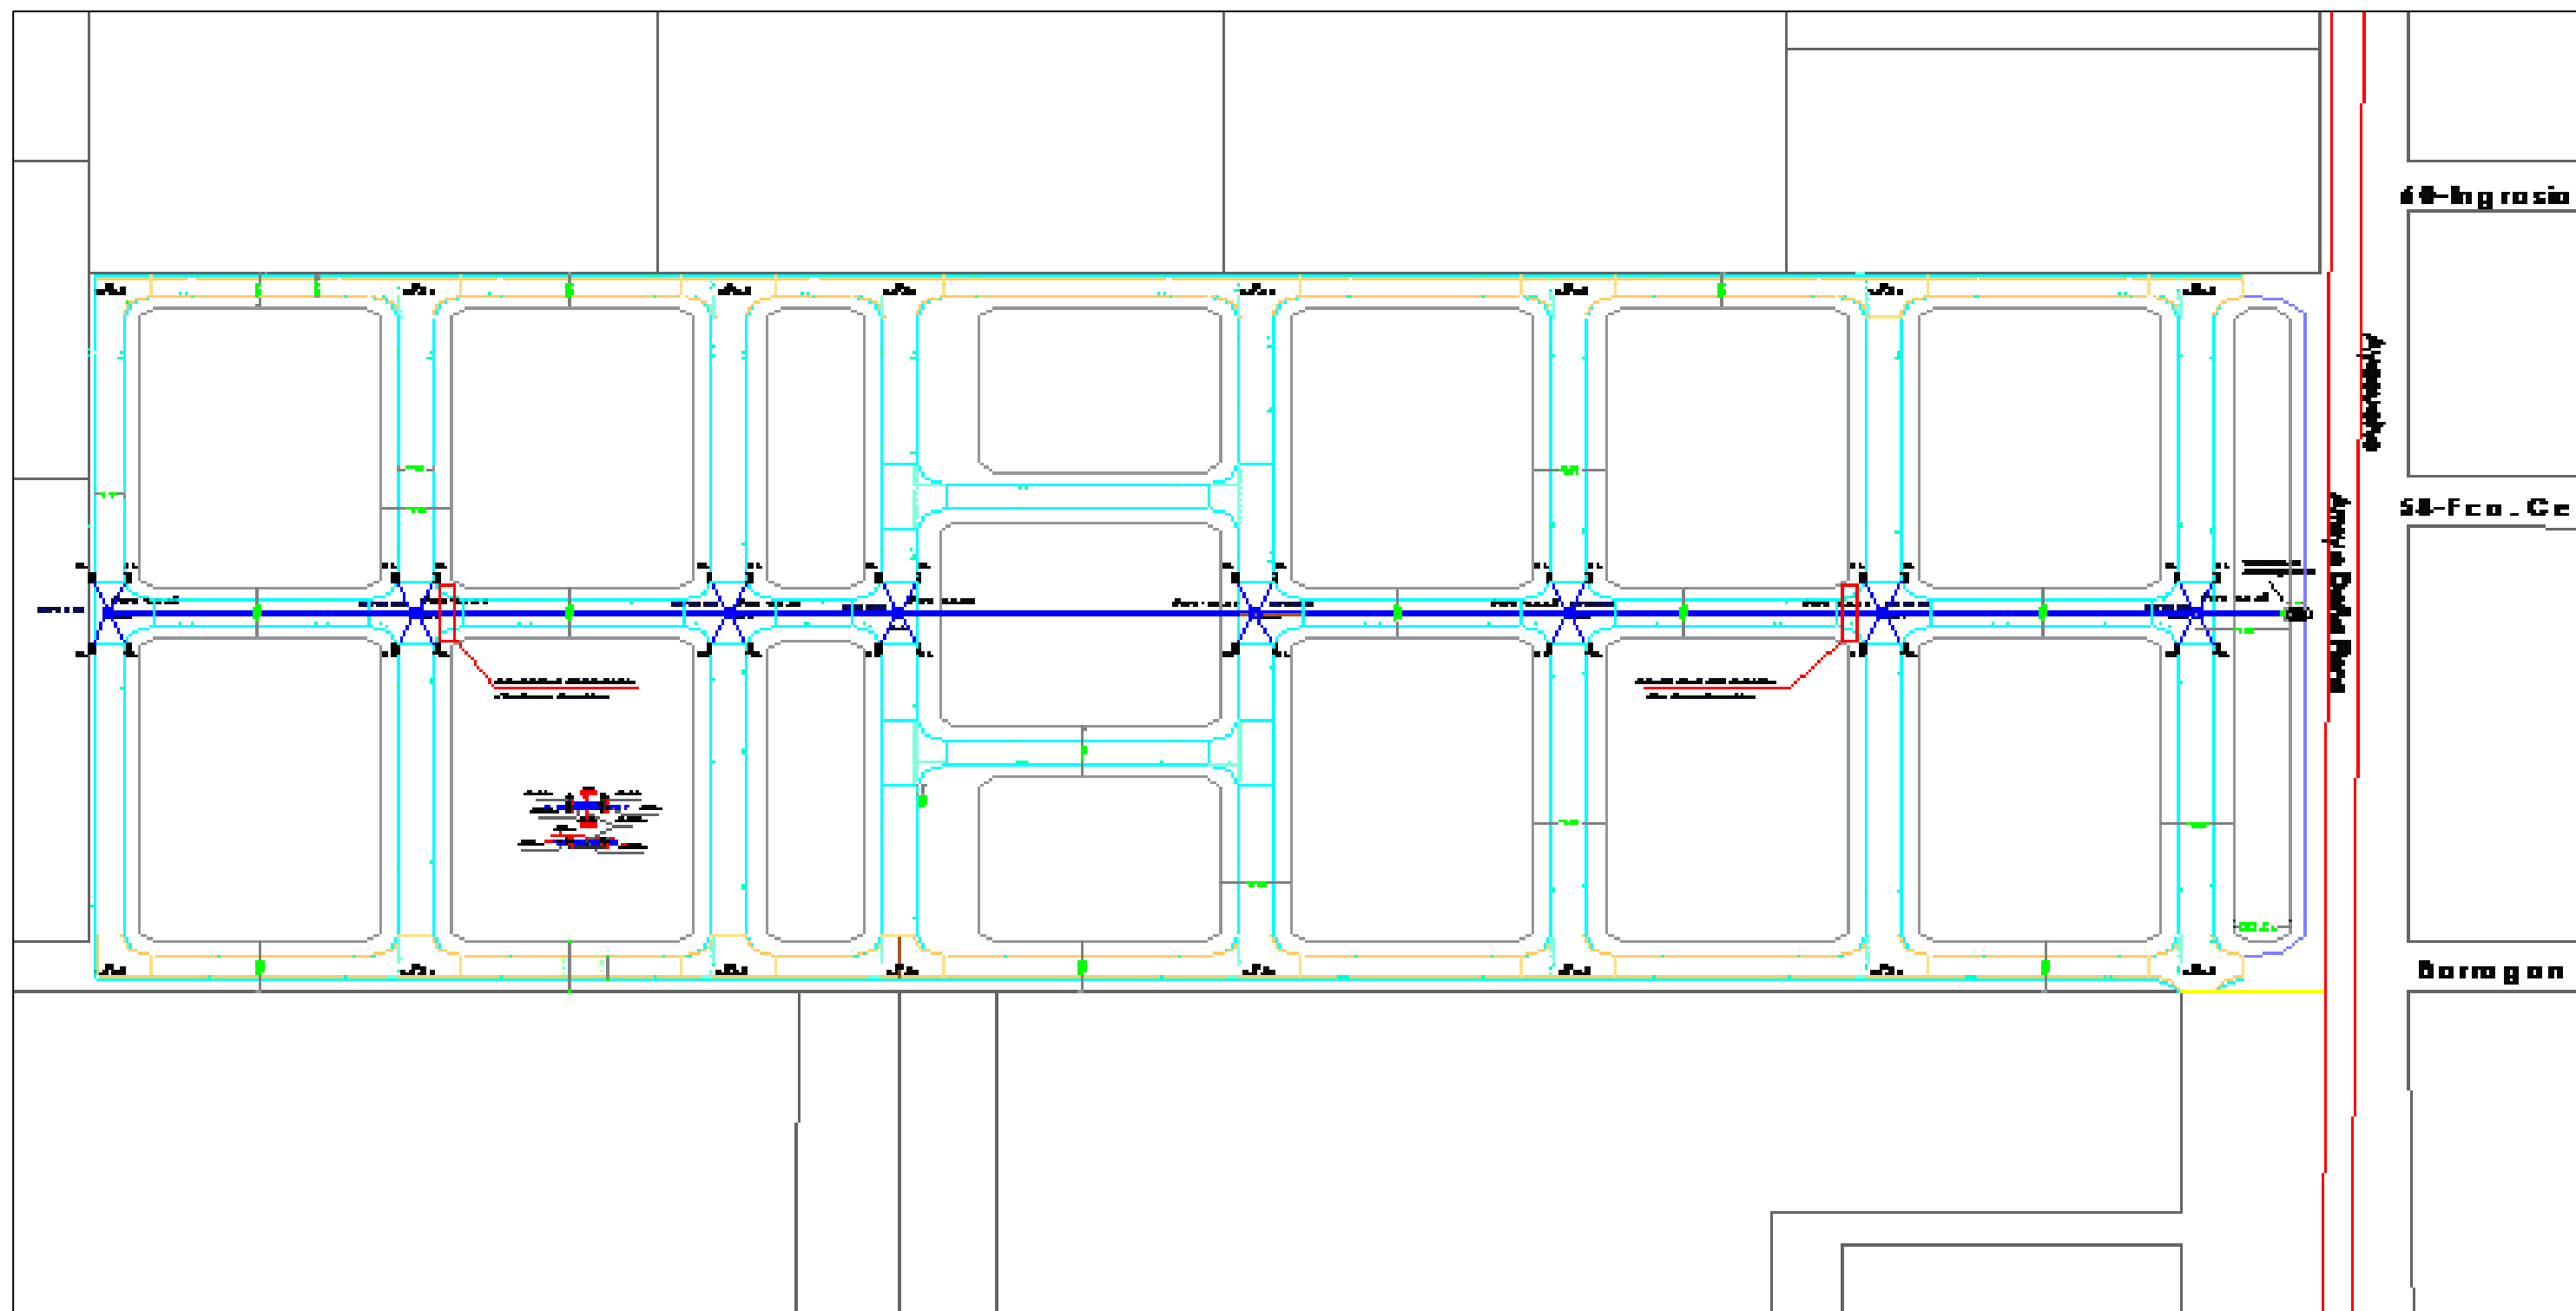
Planta general del proyecto Desagües Pluviales B° 300 Viviendas.
